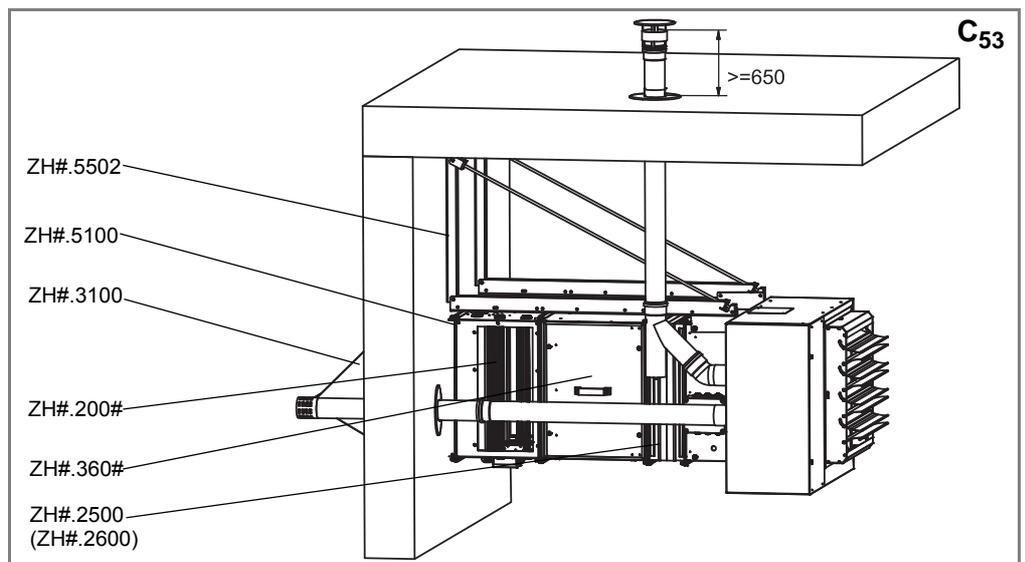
Wandausführung eines Mischluftgerätes mit Single Abgasleitung
